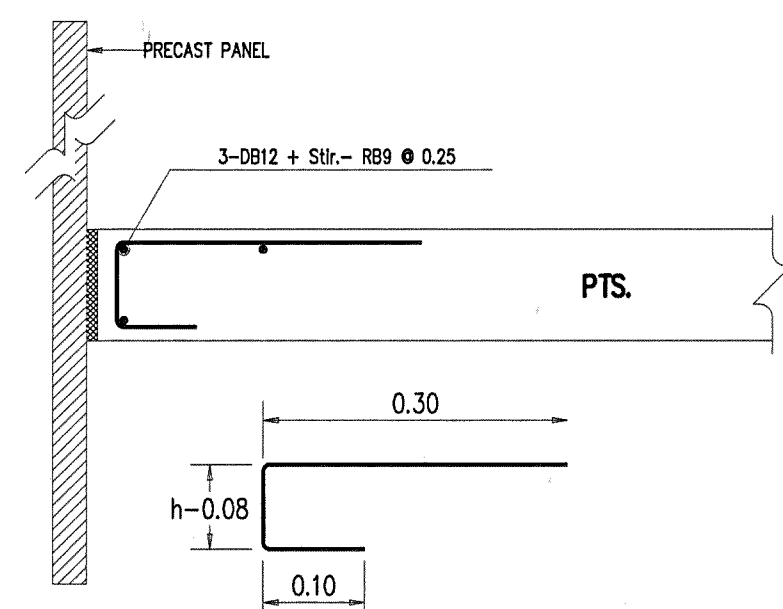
การเสริมเหล็กบริเวณหัว EXTRA ANCHORAGE
